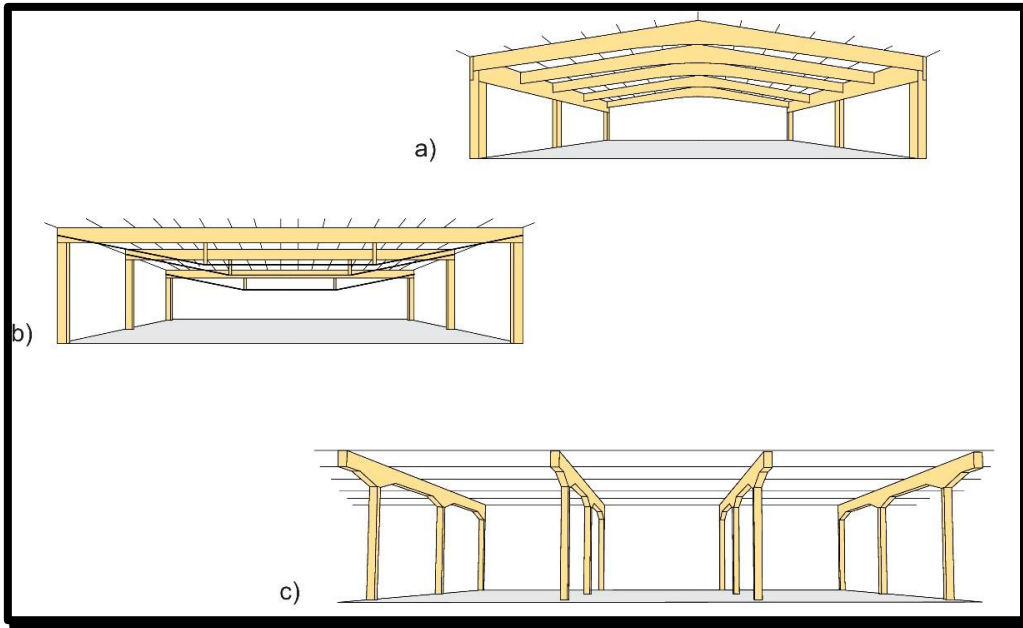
Structure en profilés (poutres et poteaux) lamellé collé de type portique.
